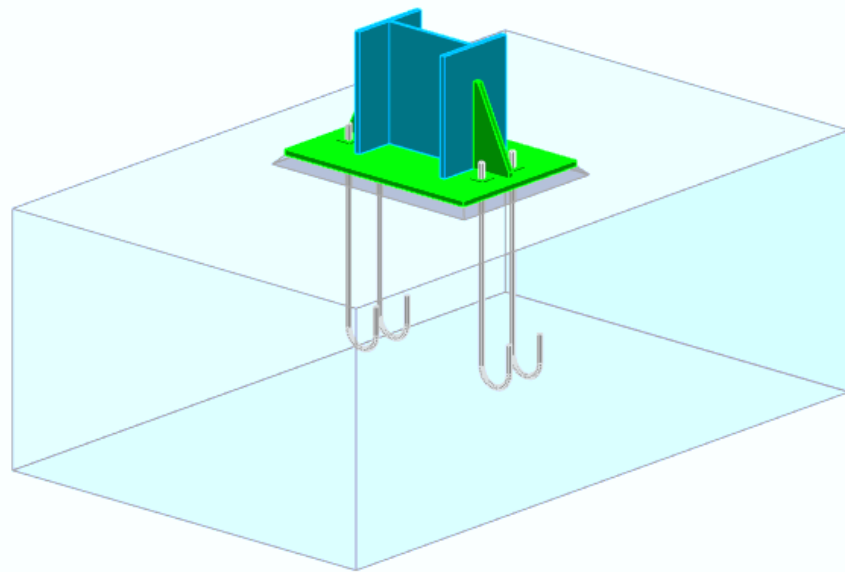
Vue 3D de l'assemblage au niveau de pied de poteau
